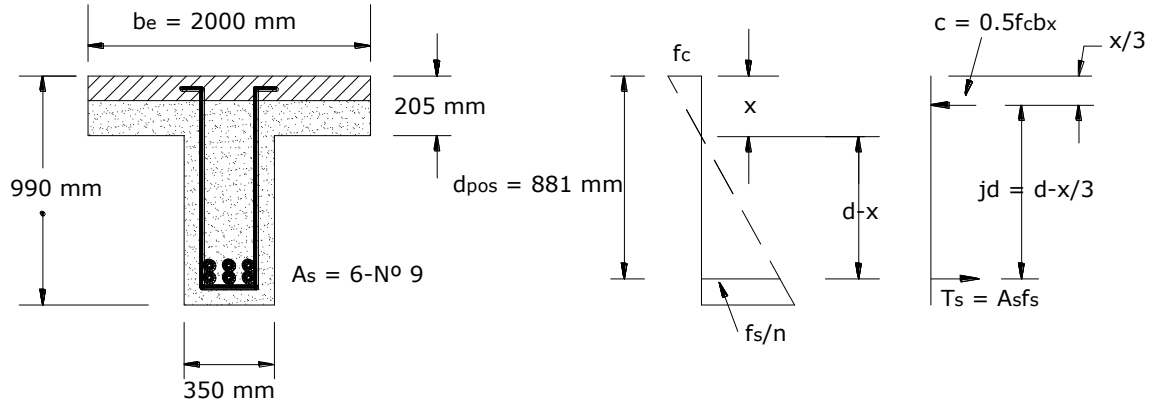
Sección fisurada para momento positivo en la ubicación 104
